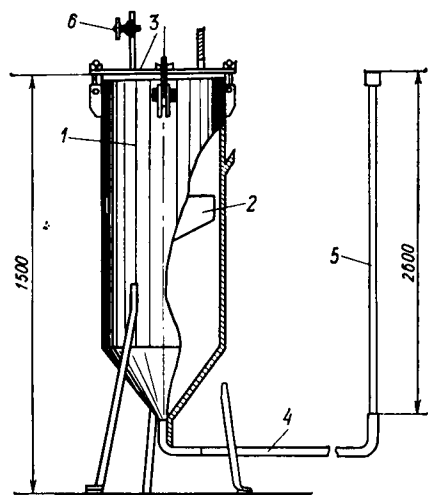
Пневмонагнетатель бетона для установки железобетонных штанг:
